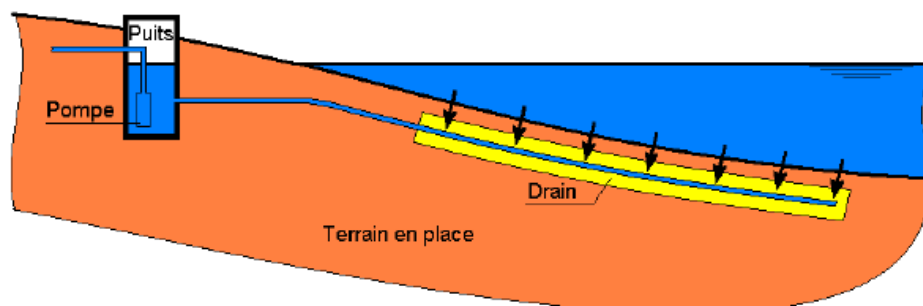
Coupe longitudinale type d'une tranchée drainante (MAUREL, 2006)
